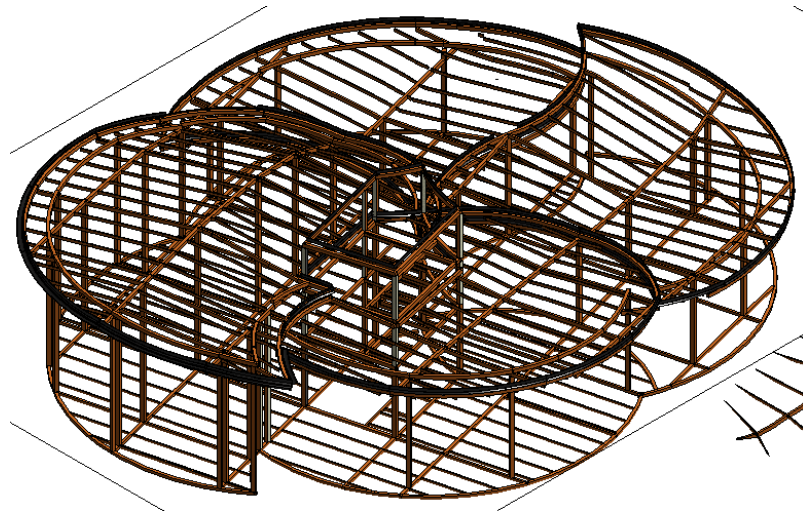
, 6, 7. 3D y forjado estructural PI. Primera
